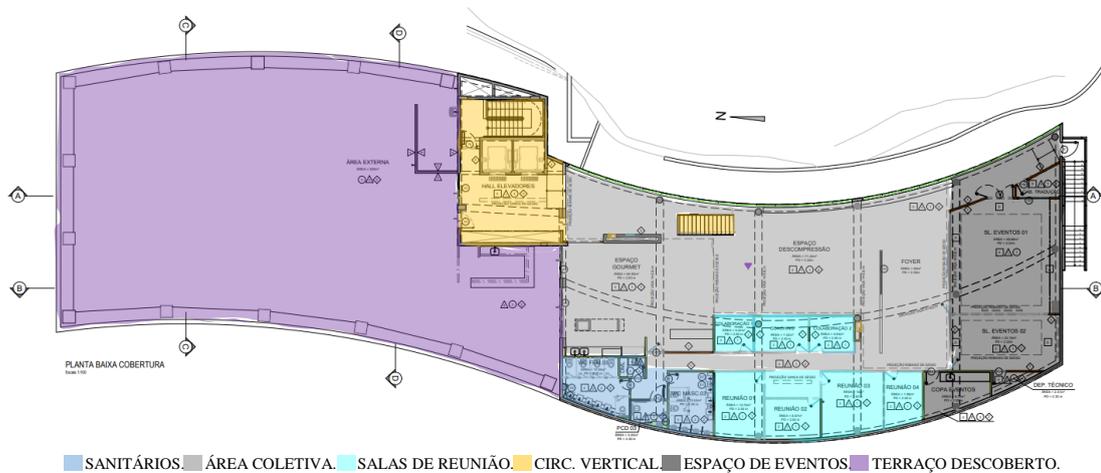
PLANTA DO PRIMEIRO PAVIMENTO
